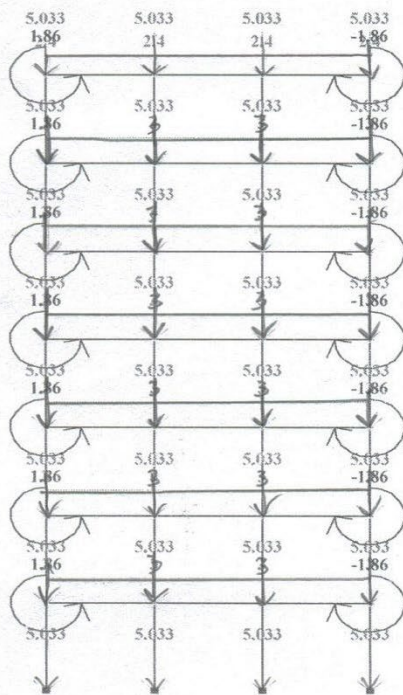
Схема завантаження рами постійними навантаженнями.
